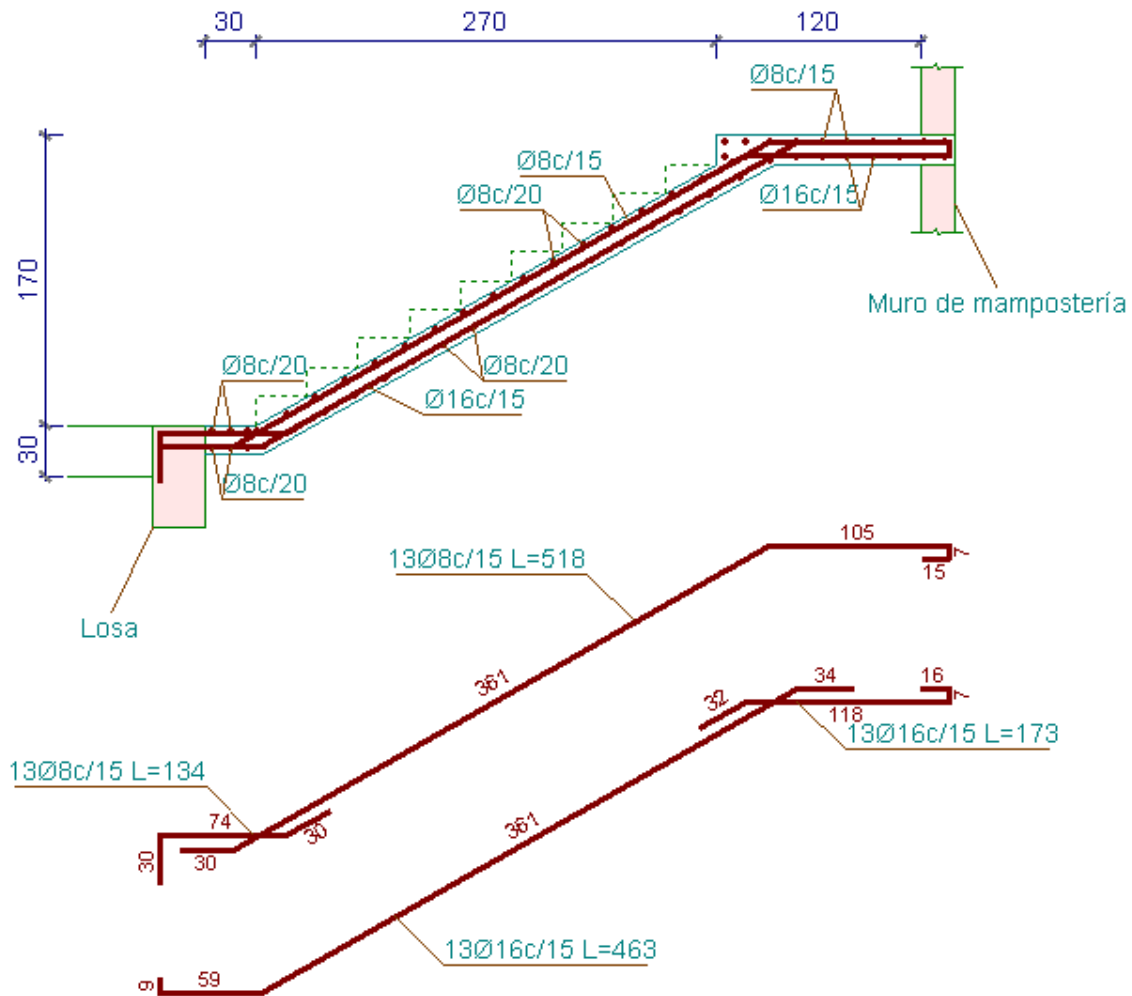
Armado de la escalera planta baja sección administrativa (A-A).
